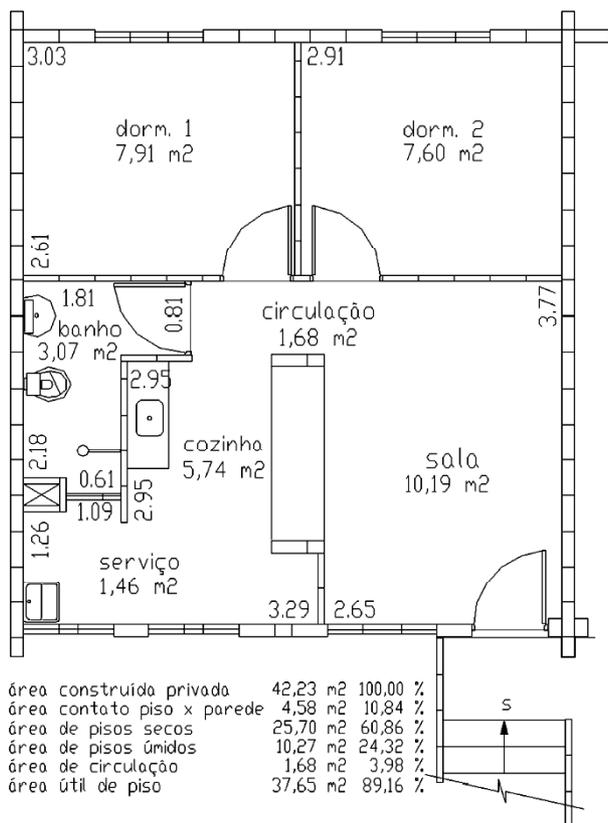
Material referencial - planta 1, apartamento padrão VG.22-A
